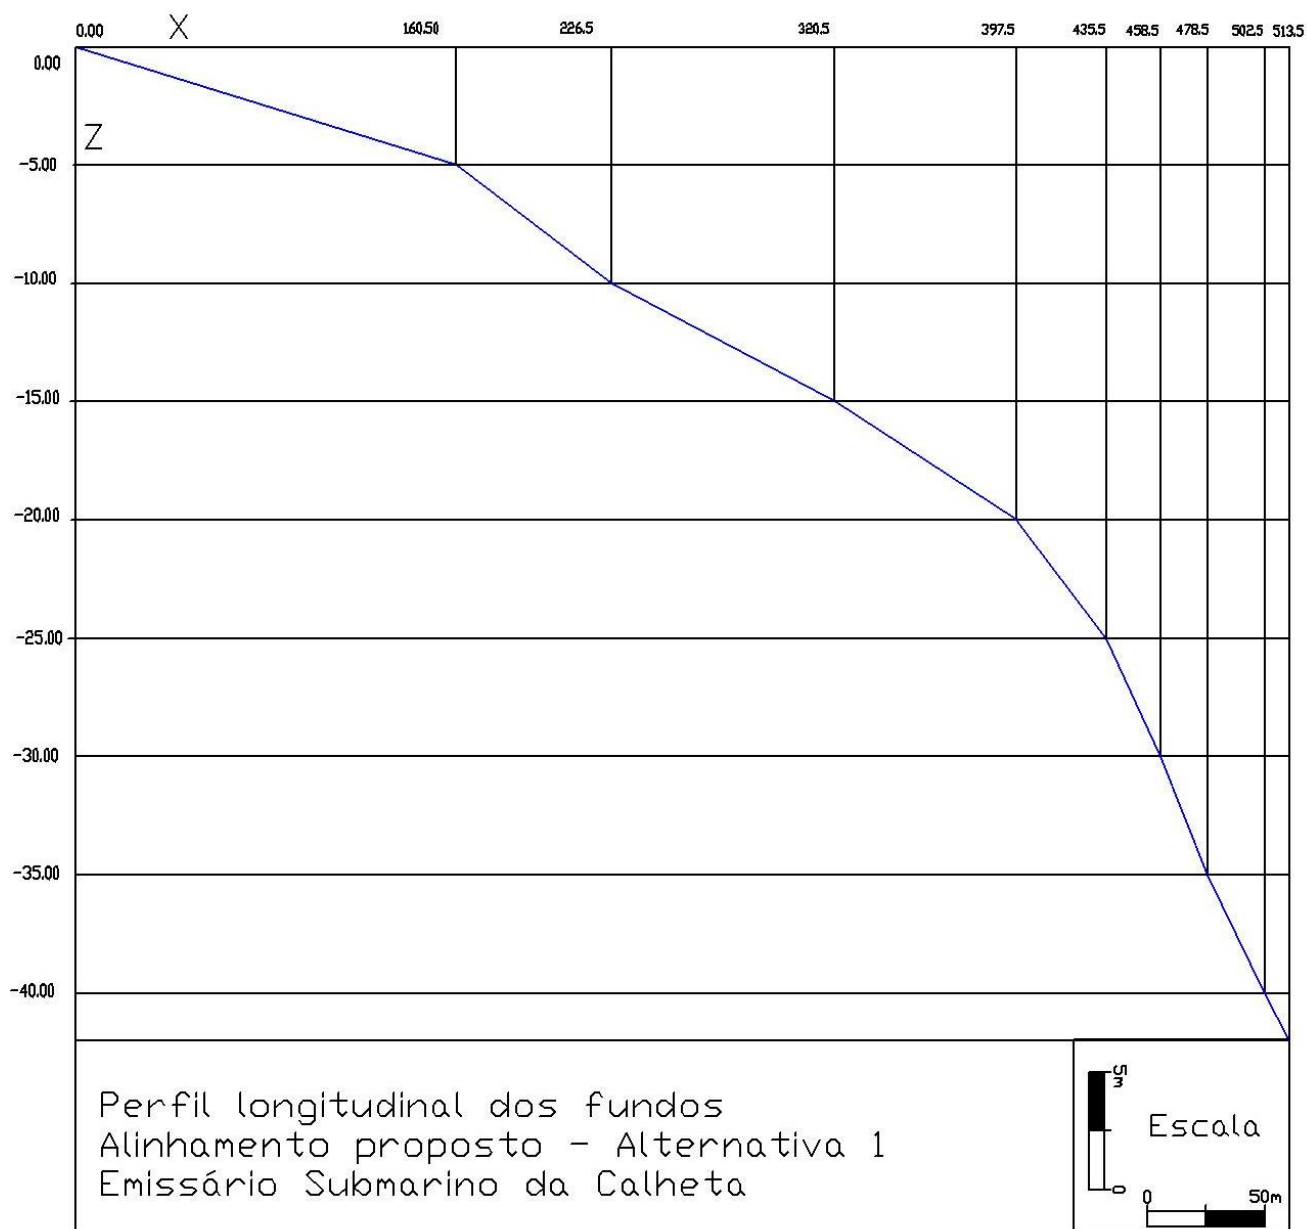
Perfil longitudinal dos fundos no alinhamento proposto para construção do emissário submarino da Calheta.
